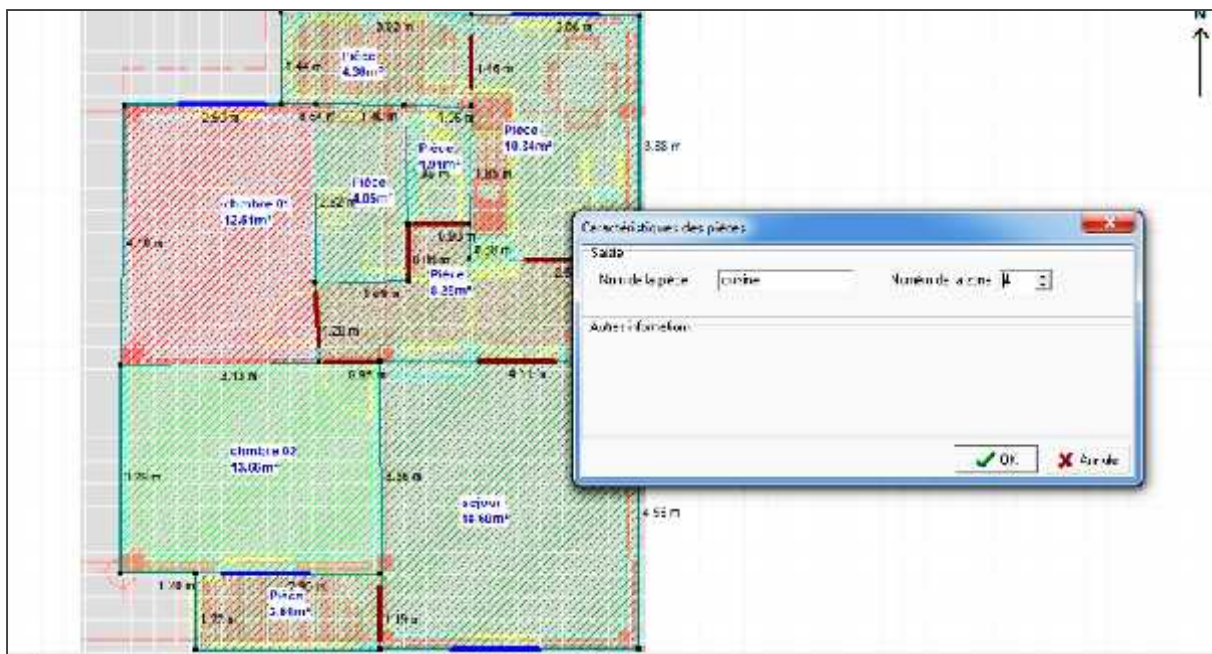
Plan du logement cas d'étude sous ALCYONE (SOURCE: auteur)
